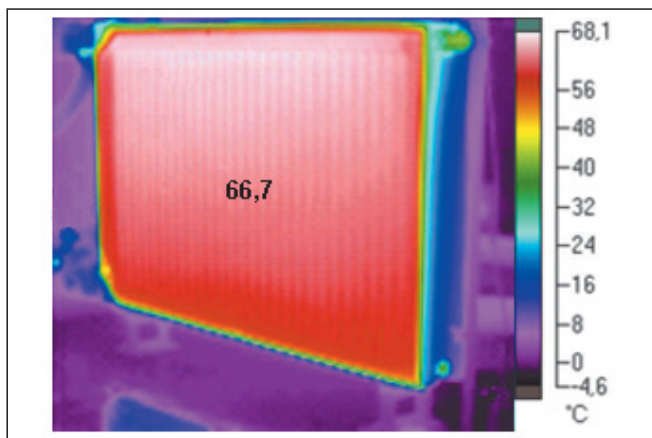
Rozdělovacím ventilem lze navolit zatékání pouze do čelní desky, částečně i do zadní nebo zvolit běžné paralelní protékání obou desek; volba aretační objímky hlavice ventilu umožňuje jeho přestavení podle toho, která deska bude montáží radiátoru zvolena jako čelní
